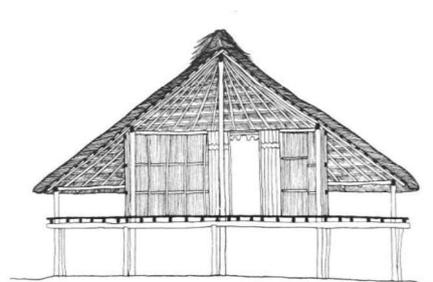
7. Conjunto de pilares independentes que sustentam a cobertura e o pavimento.
